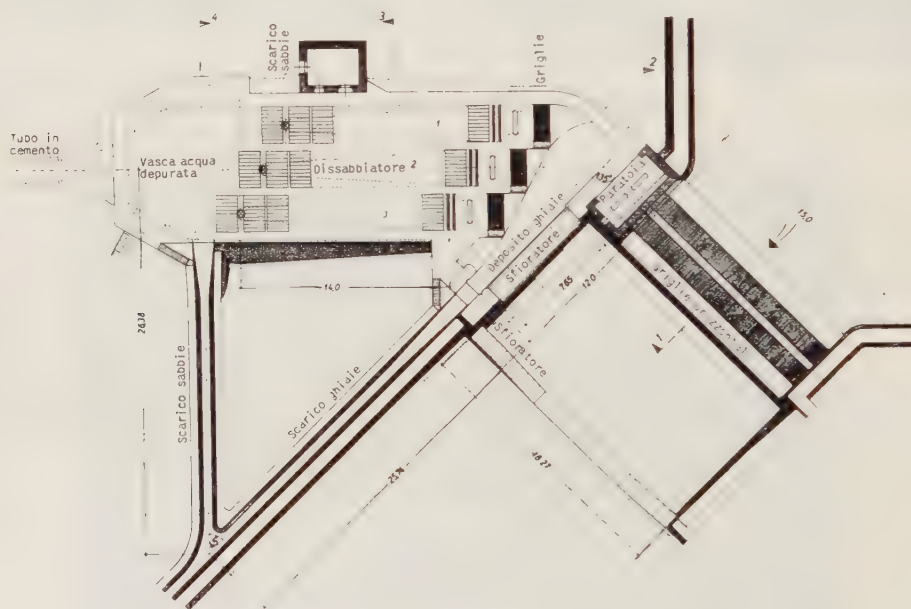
Fig. II. — Planimetria delle opere di presa sul Teuchlbach
